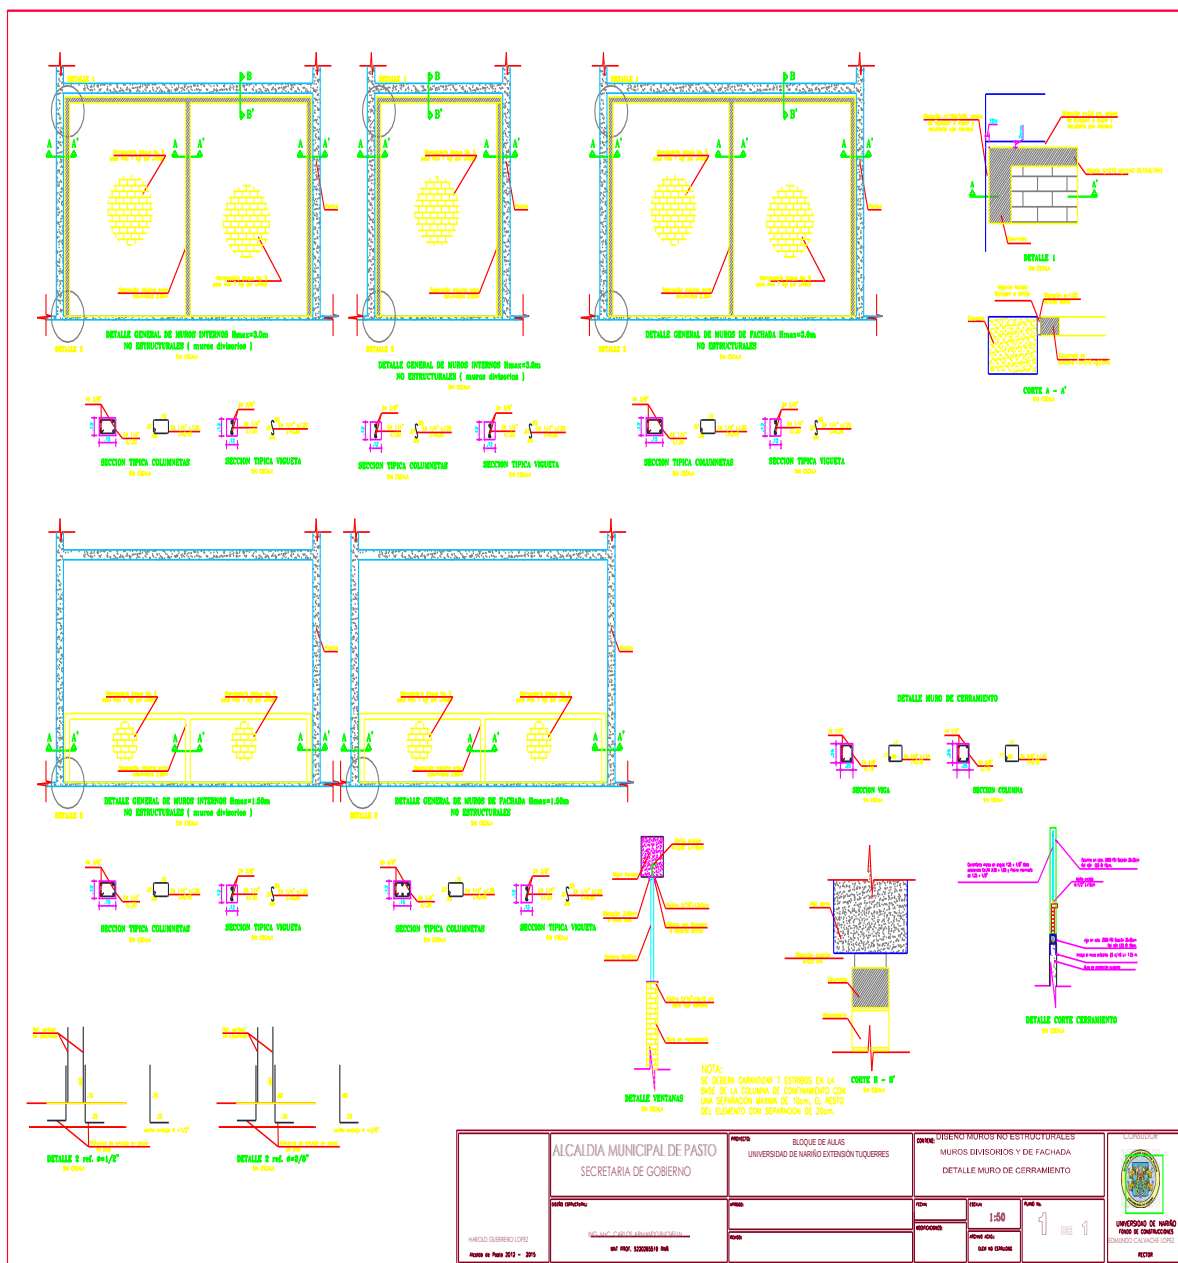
Detalles de muros divisorios, columnetas y viguetas
